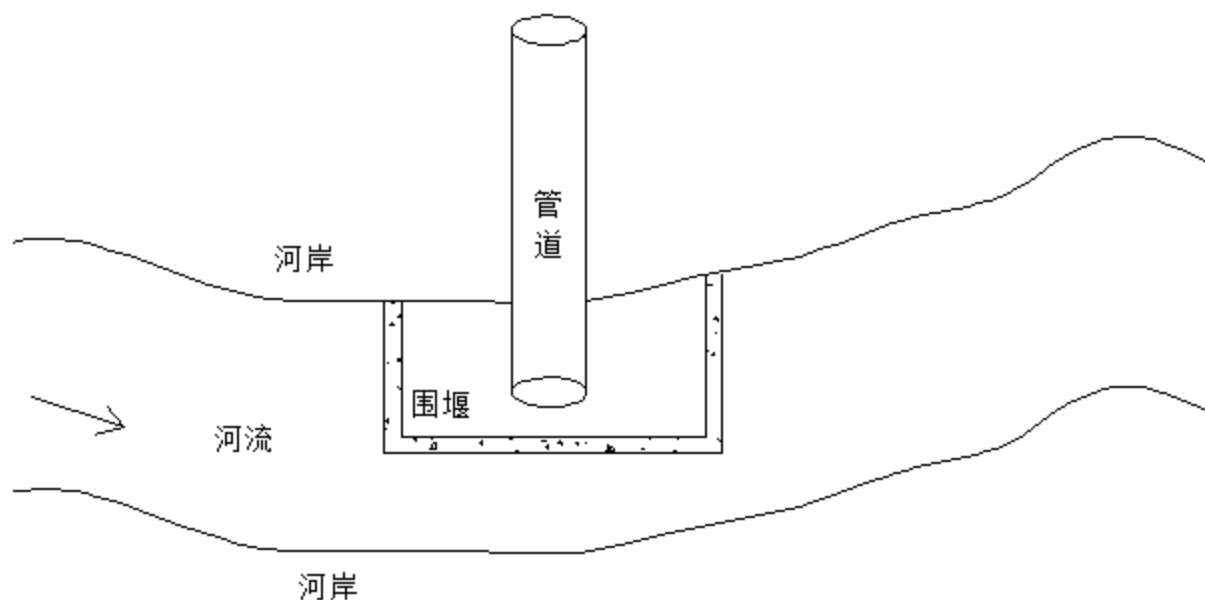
围堰导流开挖管沟法施工断面示意图
